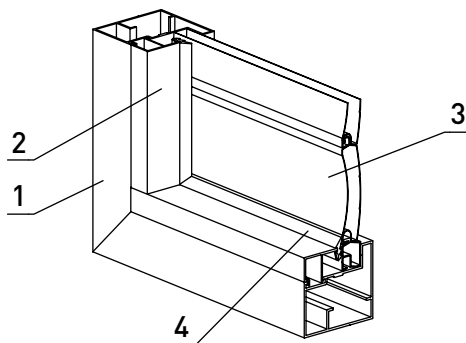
Установка штапика FLGU.400.0302, FLGU.400.0304 с уплотнителем FRK39
